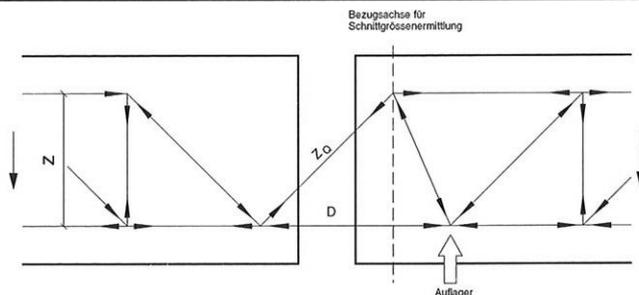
Egcobox Plattenelement Fachwerkmodell Typ PV; PV-D; PV-DD
